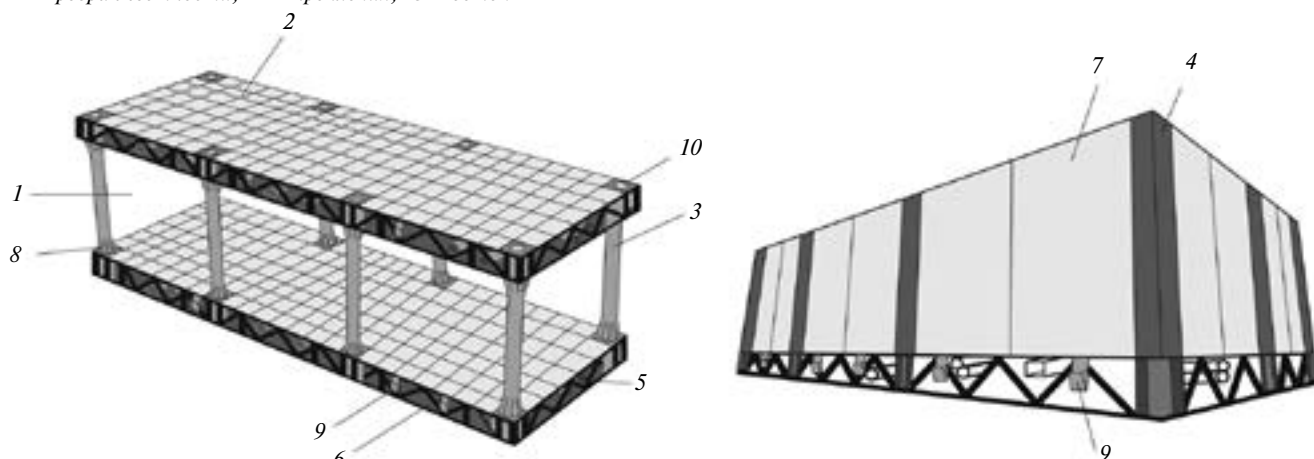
Общий вид типового строительного модуля в собранном виде: 1 – строительный модуль; 2 – пол; 3 – одноуровневые несущие колонны; 4 – ограждающие панели; 5 – встроенные инженерные сети; 6 – металлический нижний пояс; 7 – стеклопакеты; 8 – ребра жесткости; 9 – крепления; 10 – бетон
